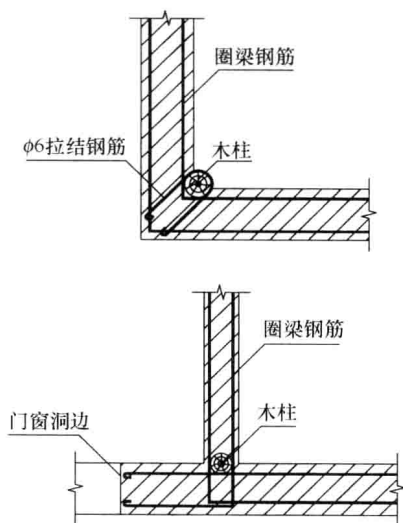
配筋砖圈梁、配筋砂浆带与木柱的拉结
